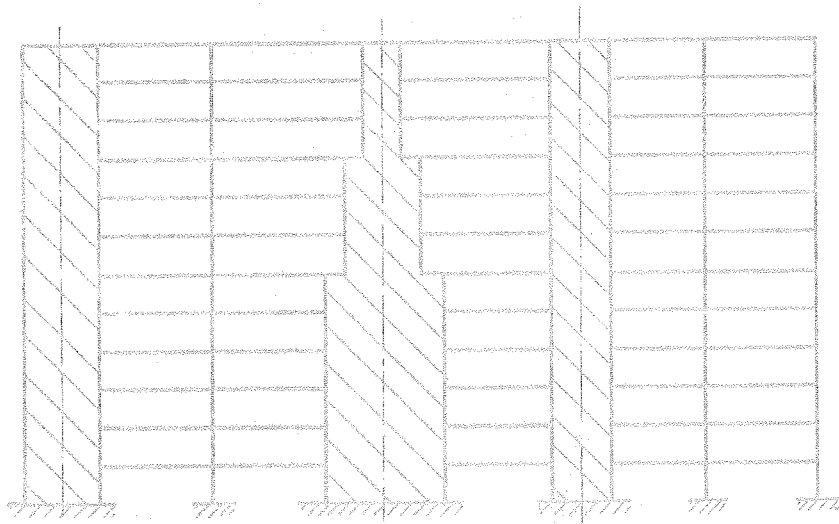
ASSOCIAÇÃO PLANA DE PÓRTICOS COM PILARES-PAREDES
